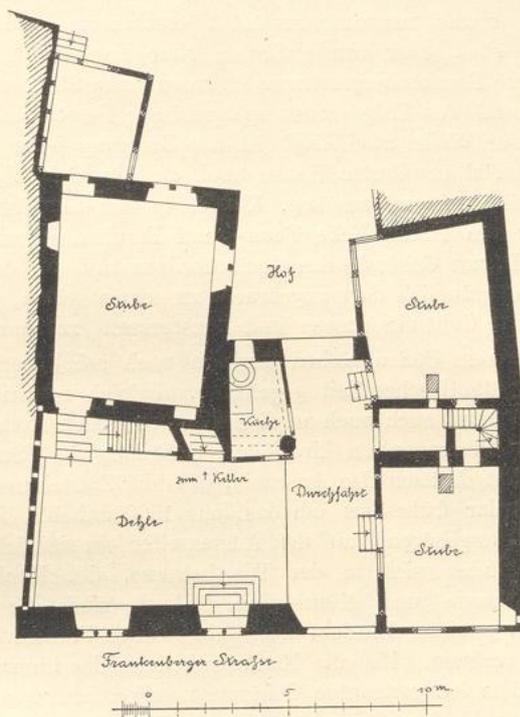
Goslar, Frankenbergstrasse 11; Grundriss.
